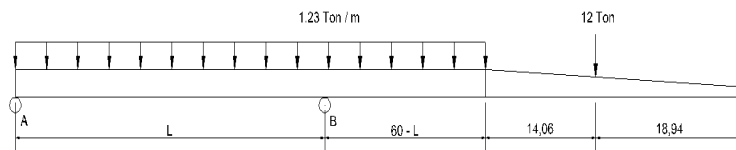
Centro de gravedad del conjunto puente-nariz.
